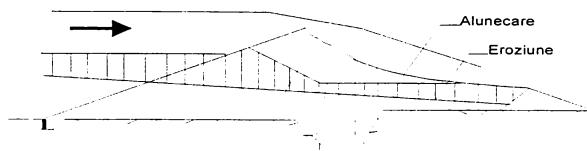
Barajul Belci. Alunecarea taluzului aval.
